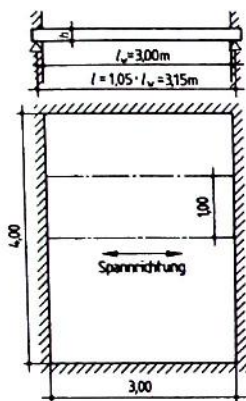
Stahlbetondecke in einem Wohnhaus
